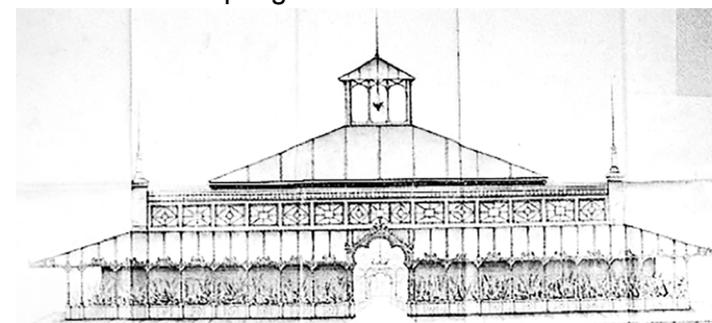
Alzado del proyecto de J. Zacarías Camaña
